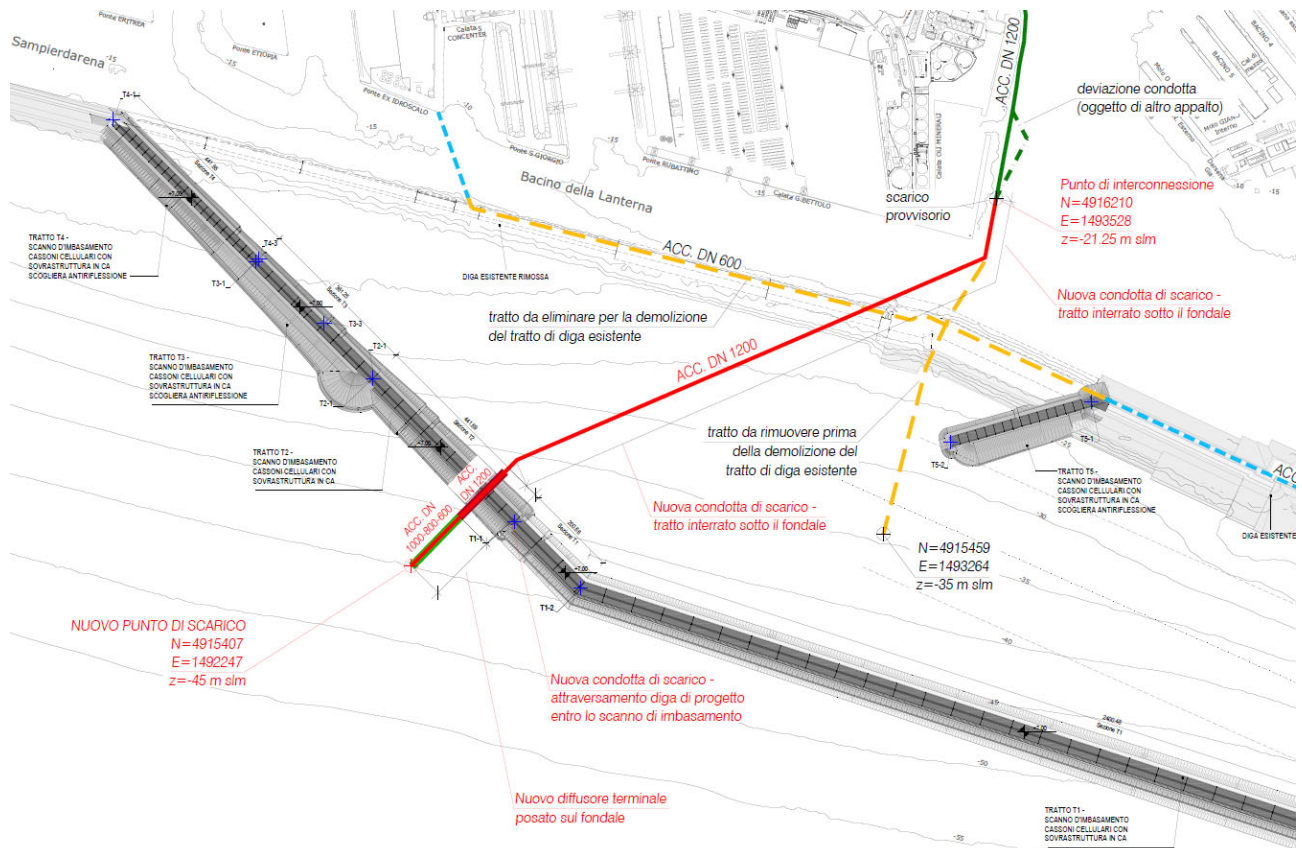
Tracciato planimetrico della condotta di scarico a mare di progetto.
